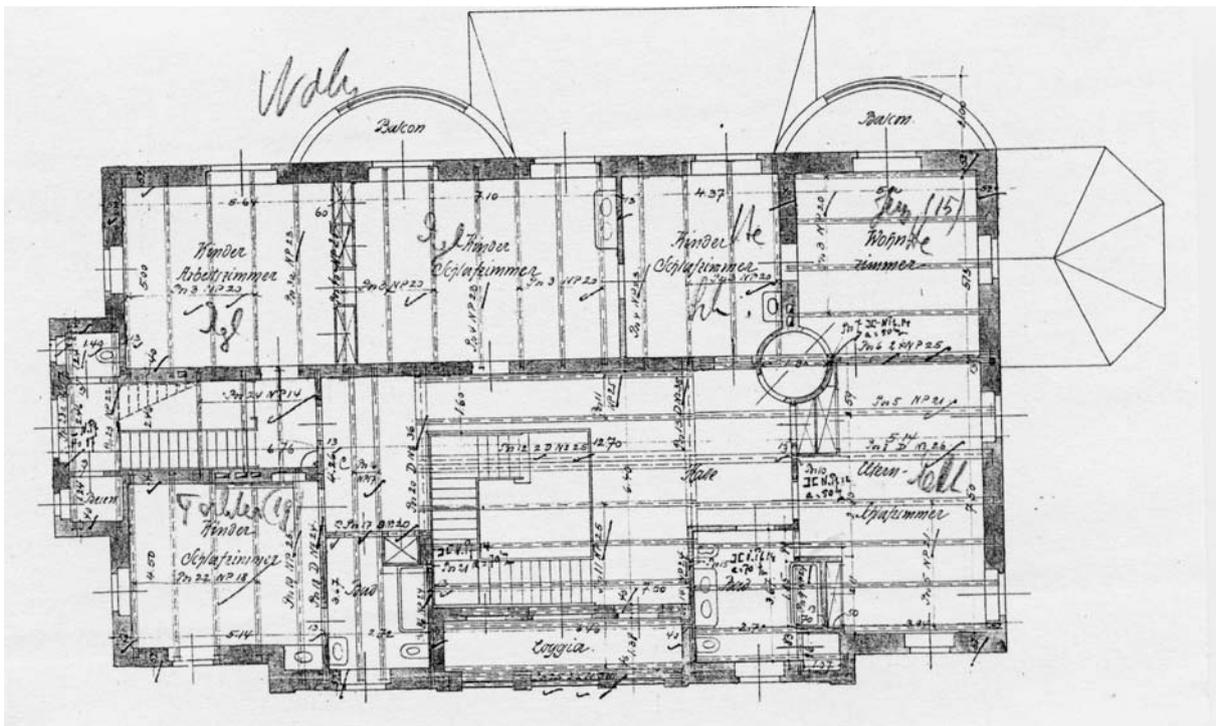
H. Plange, Grundriss Obergeschoss, 1913
